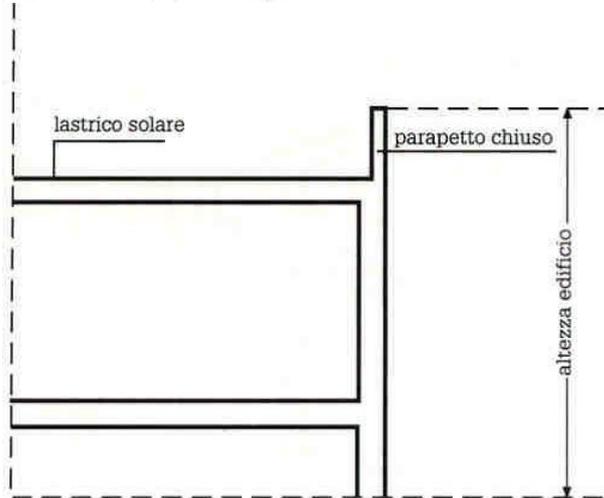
Edificio con copertura piana, parapetto chiuso e lastrico solare
